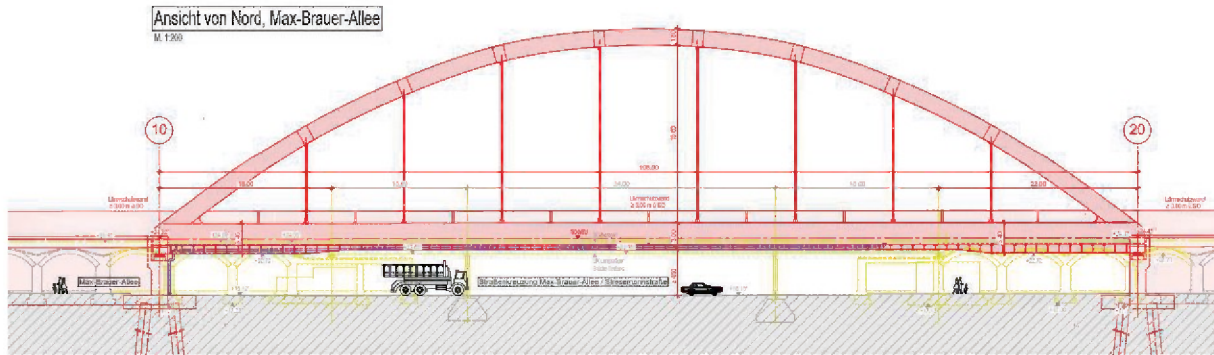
Seitenansicht Vorzugsvariante DB, Quelle: [1] Anlage 9.1 - Plan VP_Ib_A09_AS_002
